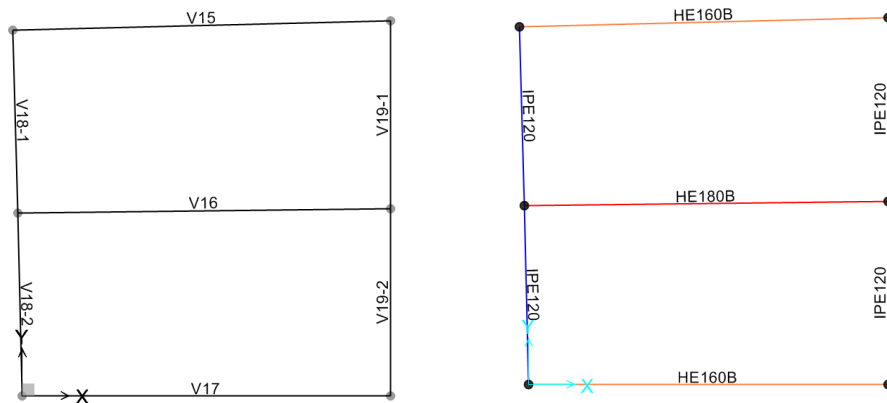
Numeração e secções das vigas metálicas do piso 3 (V15 a V19)
